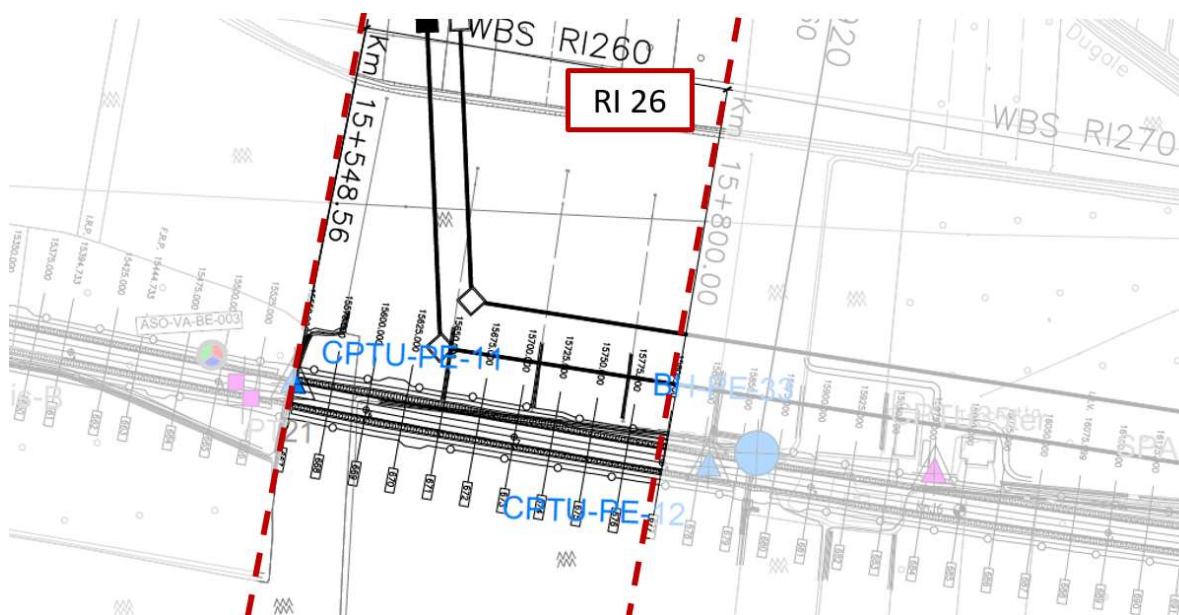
Planimetria Rilevato RI26, estratto dalla Planimetria Generale (Doc. Rif. [3])
